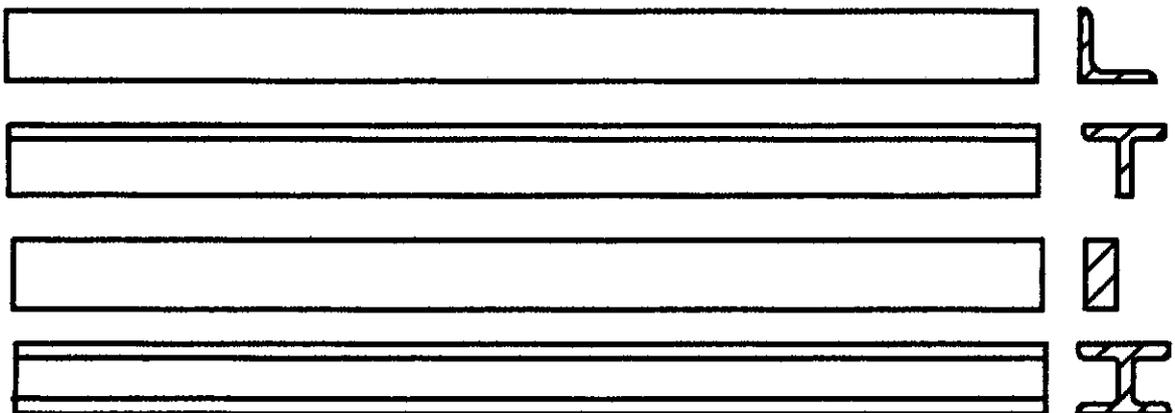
Secciones simples utilizadas en la construcción de estructuras (Perfil angular, Perfil en Te, Perfil rectangular y perfil en I)
